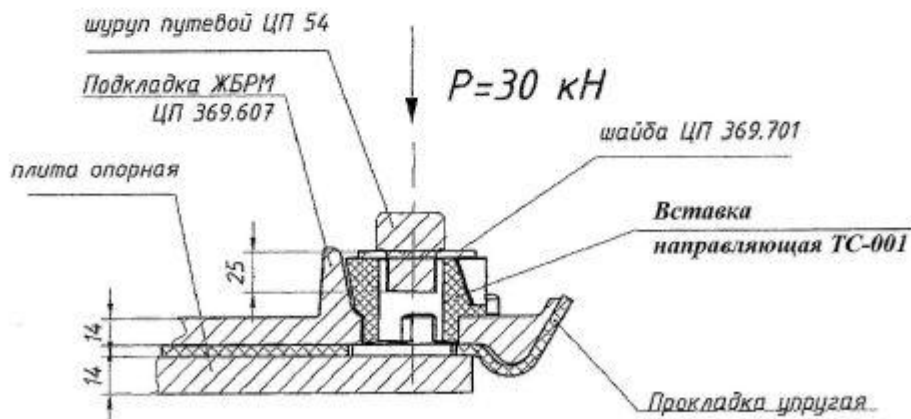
Схема испытания вставки направляющей на сжатие
